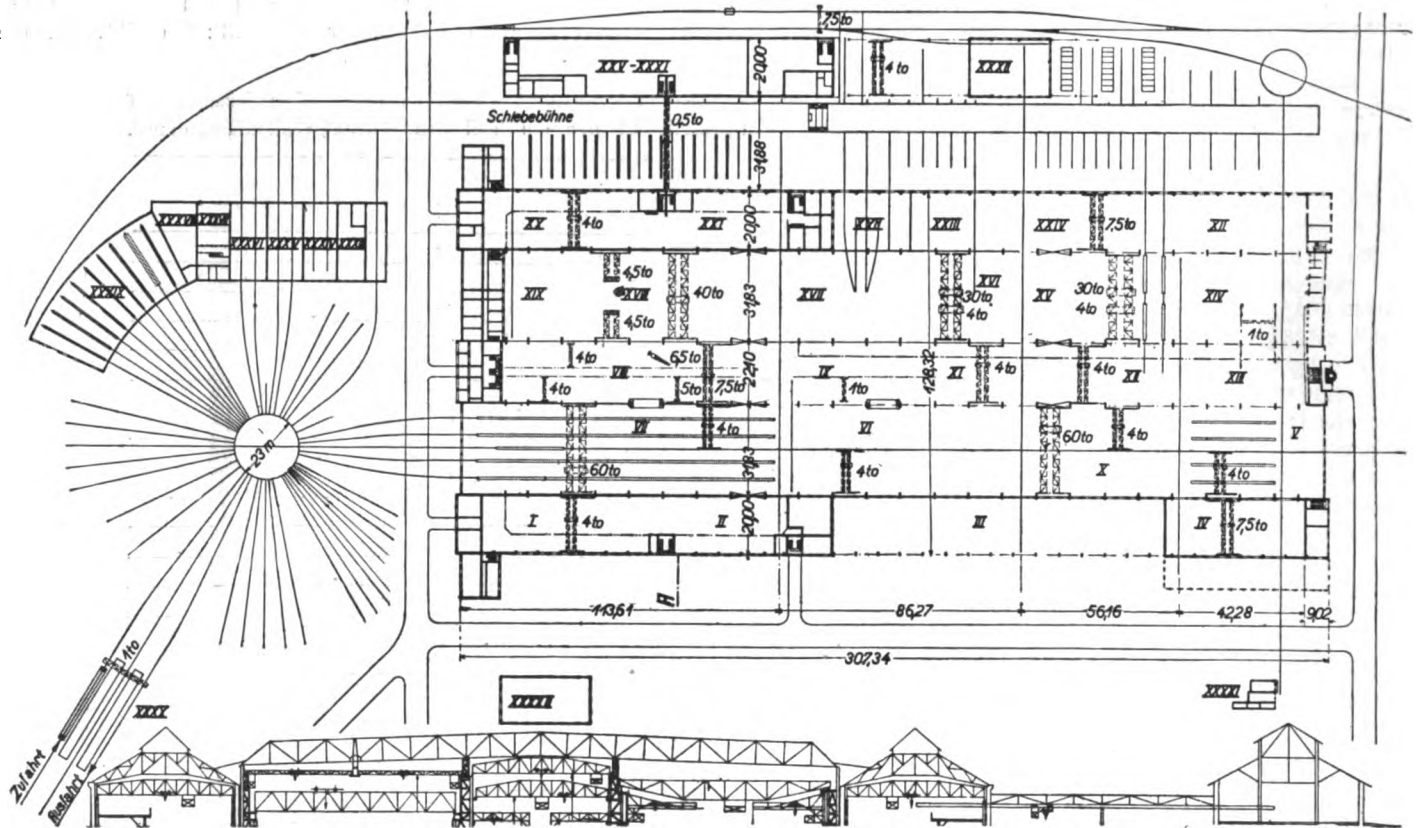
Grundriss und Querschnitt des Lokomotivausbesserungswerkes im Eisenbahnwerk Brandenburg-West. I. Treibteilewerkstatt. II. Pumpen- und Armaturenwerkstatt. III. Frei für Erweiterung. IV. Abkocherei. V. Zerlegung. VI. Rahmenwerkstatt. VII. Zusammenbau. VIII. Räderwerkstatt. IX. Rahmenteilwerkstatt. X. Rahmenreinigung. XI. Brems- und Zügwerkstatt. XII. Blech- und Behälterwerkstatt. XIII. Kupferschmiede. XIV. Schmiede. XV. Tenderwerkstatt. XVI. Kesselzerlegung. XVII. Kesselbohrstände. XVIII. Kesselrichtstände. XIX. Kesselprüfstände. XX. Ersatzteilewerkstatt. XXI. Kesselteilewerkstatt. XXII. Sandstrahlreinigung. XXIII. Überhitzerwerkstatt. XXIV. Rohrwerkstatt. XXV—XXXI. Stofflager, Ersatzteillager, Werkzeugmacherei, Zentralgeräteverwaltung. XXXII. Eisenlager. XXXIII. Wärmespeicheranlage. XXXIV. Kessel-Dampfdruckprobe. XXXV. Abrüststand. XXXVI. Anheizstand. XXXVII. Gerätelager. XXXVIII. und XXXIX. Nachreparaturwerkstatt. XXXX. Be- und Entkohlungs.
